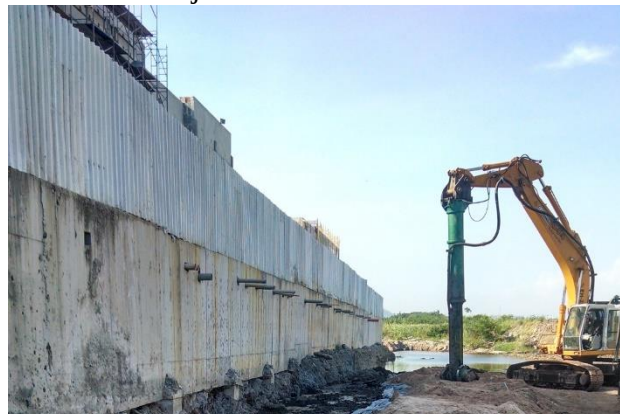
Foto do Equipamento de execução, em trecho tratado com o aterro de pré-carregamento já executado
